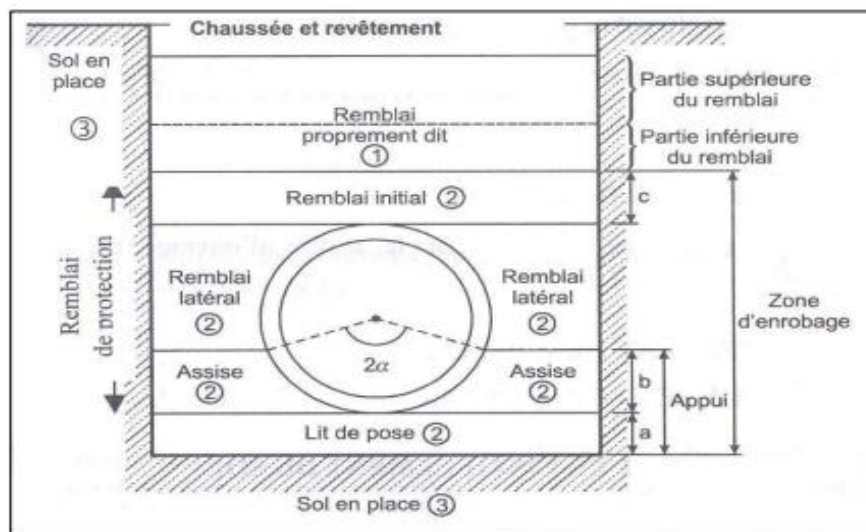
Schéma d'une tranchée avec une conduite
